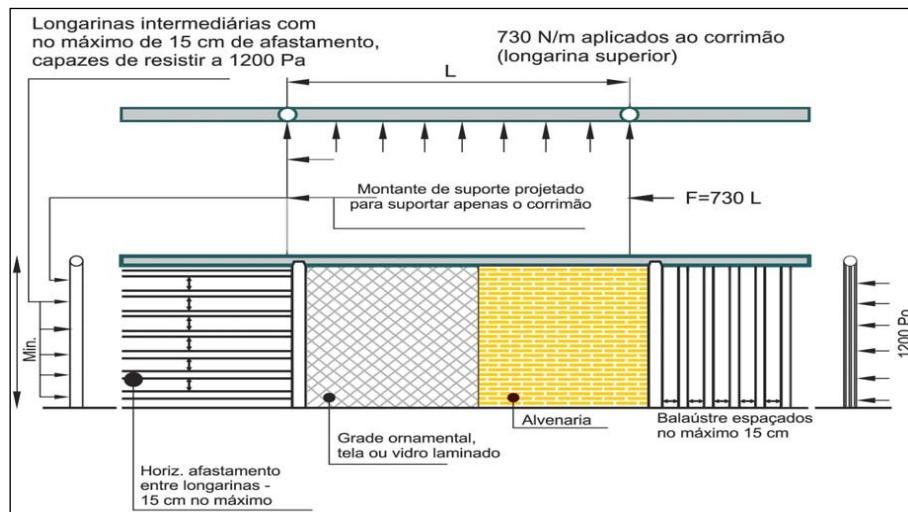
Pormenores construtivos da instalação de guardas e as cargas a que elas devem resistir
